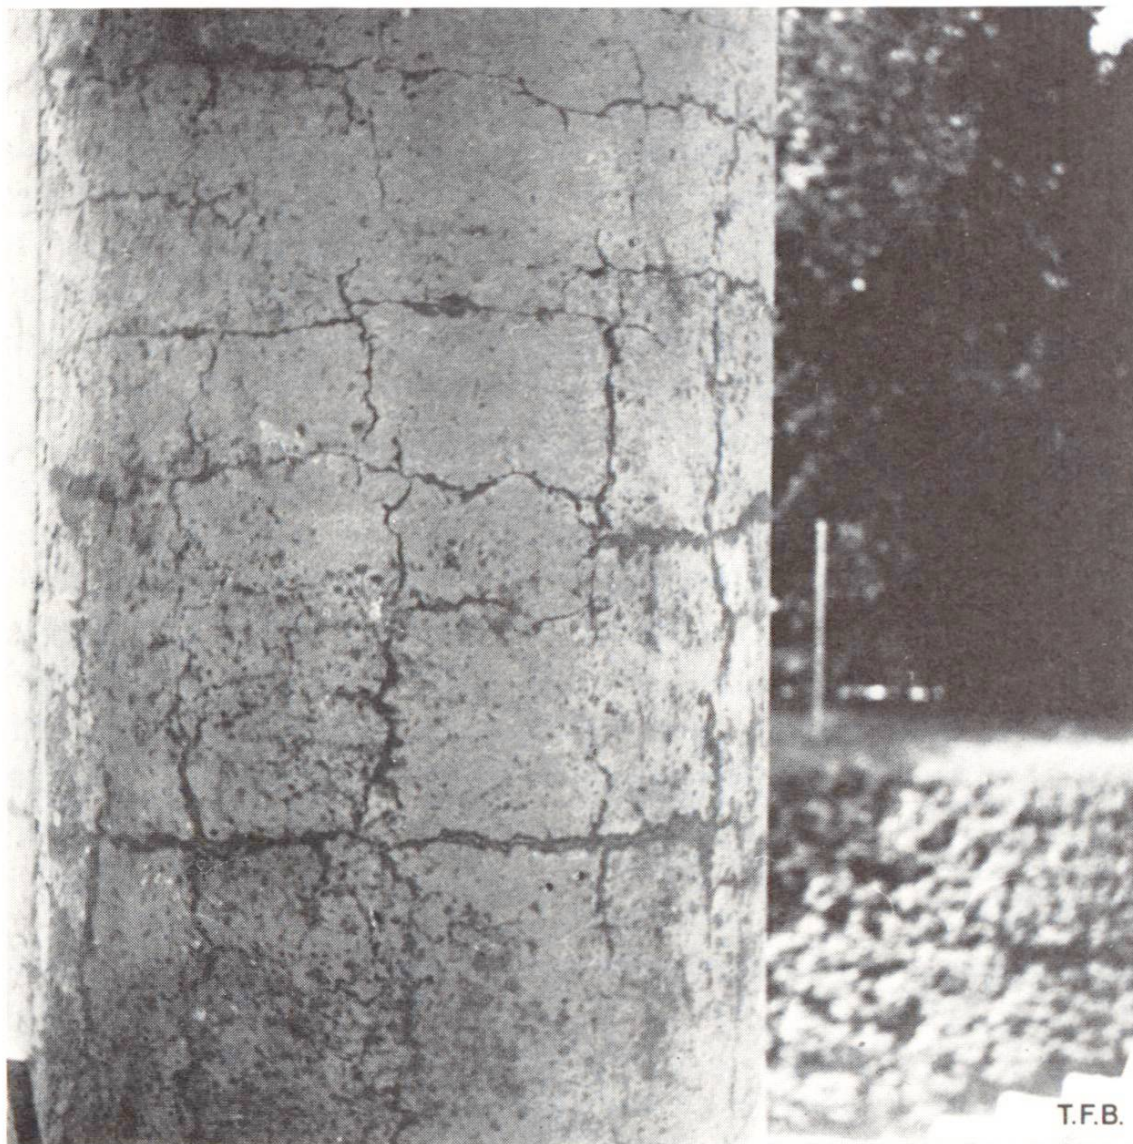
Fissures en réseau à mailles carrées sur un pylone en béton. Elles sont dues soit à la forme cylindrique du pylone, soit à l'influence de l'armature.
